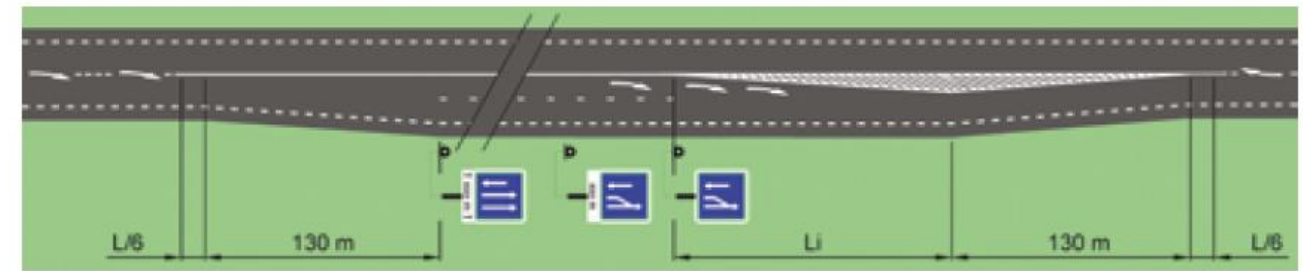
Schéma de construction d'un créneau de dépassement - ARP 2022
